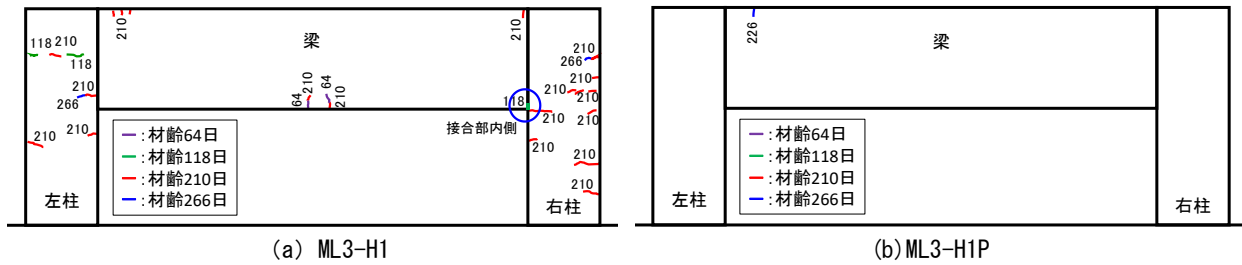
ひび割れの発生状況(図中の数値はひび割れ確認時の材齢(日))
